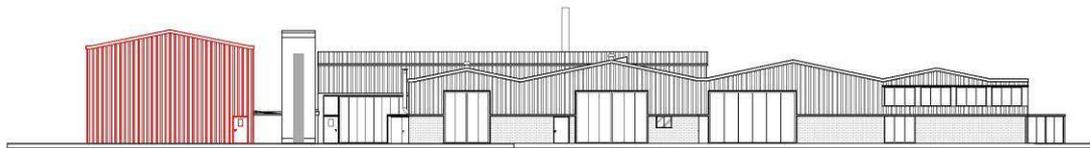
planimetria dell'area dell'area di intervento (in rosso l'ampliamento previsto)
